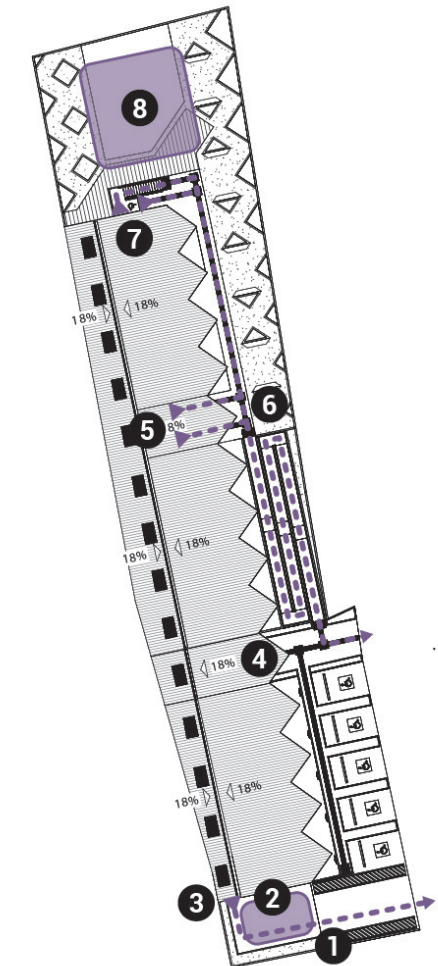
Planta diagrama de evacuación. Elaboración propia.
